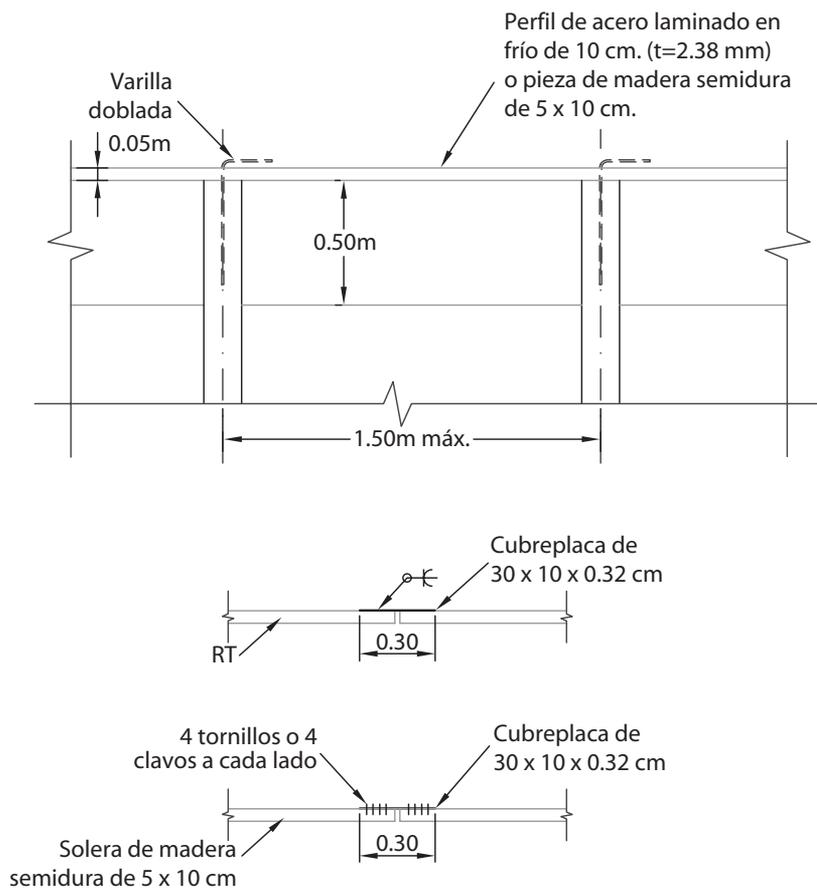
Detalles de soleras para las paredes de paneles o baldosas, horizontales o verticales de concreto reforzado.
